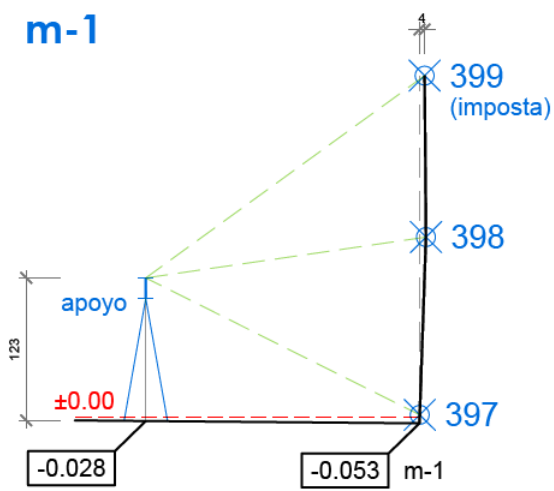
Levantamiento de muros del ábside Norte (elaboración propia).
